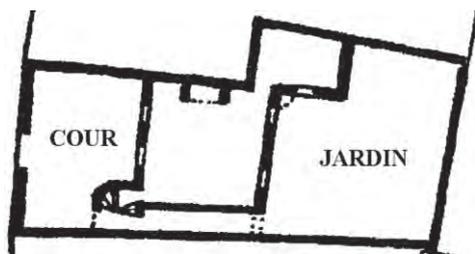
TOULOUSE, PLAN AU SOL DE L'HÔTEL MOLINIER, proposition de reconstitution de l'état de la demeure vers 1556, d'après le plan publié dans Papillault 1996, p. 169.
